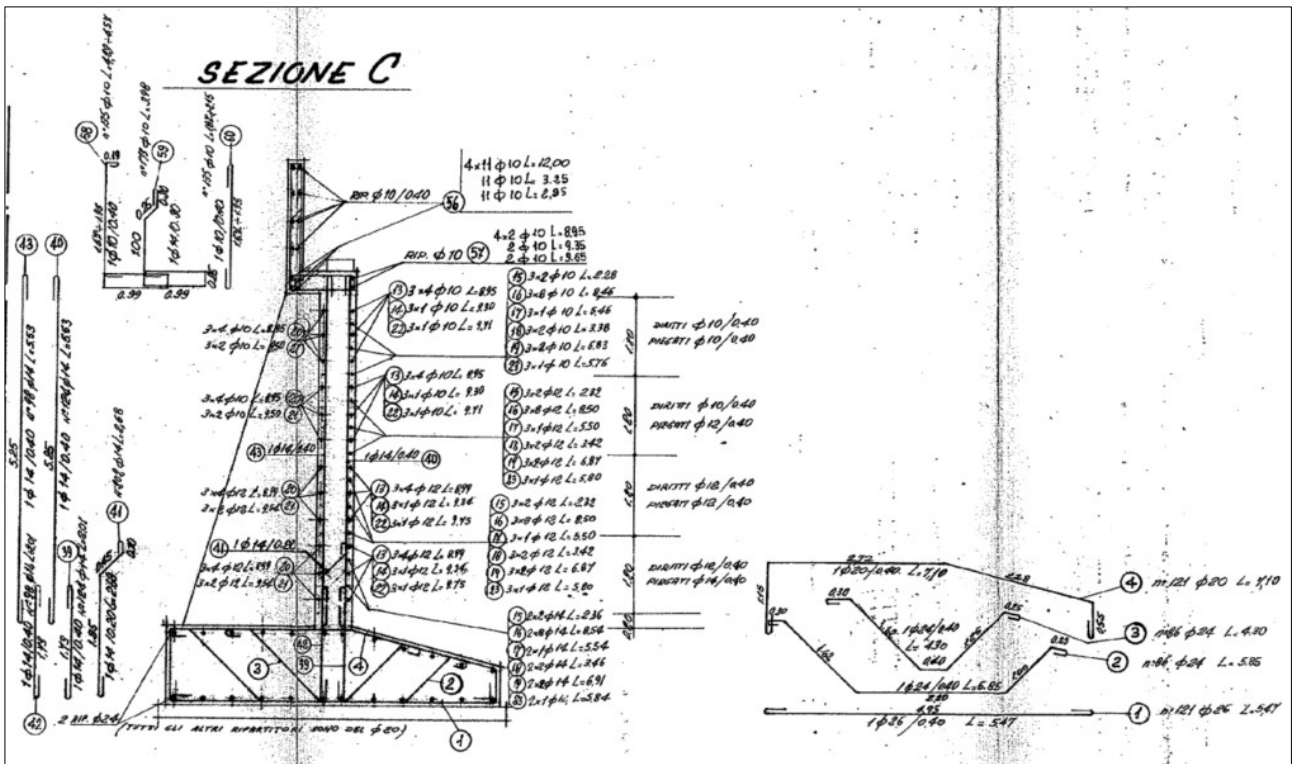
Documento as-built “Sottovia Via del Triumvirato dell’autostrada A14 al km 9+201” – Sezione trasversale con armature spalla
